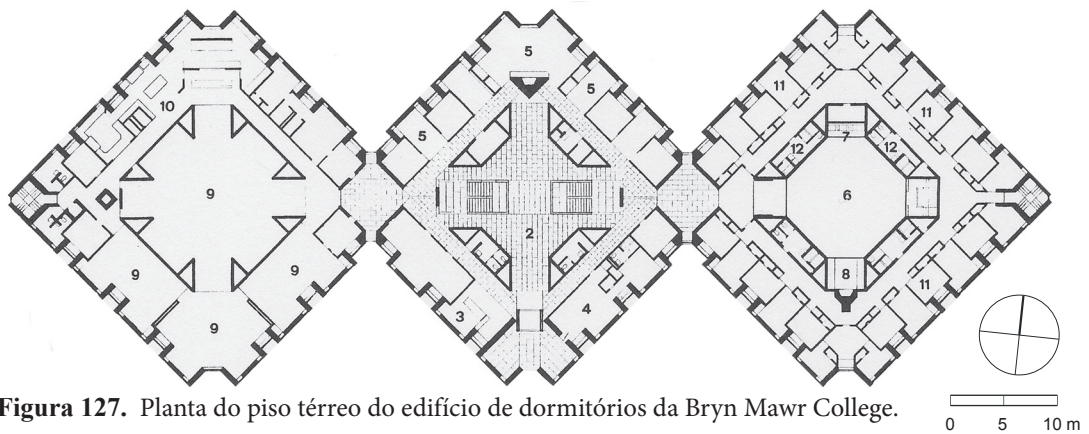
Planta do piso térreo do edifício de dormitórios da Bryn Mawr College.
